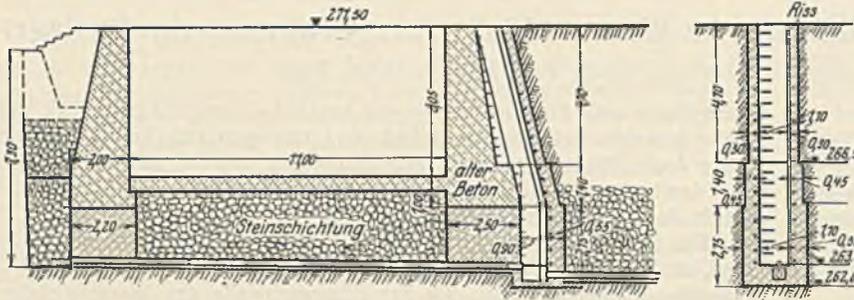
Entwässerungsschlitzz mit Revisionschacht.
